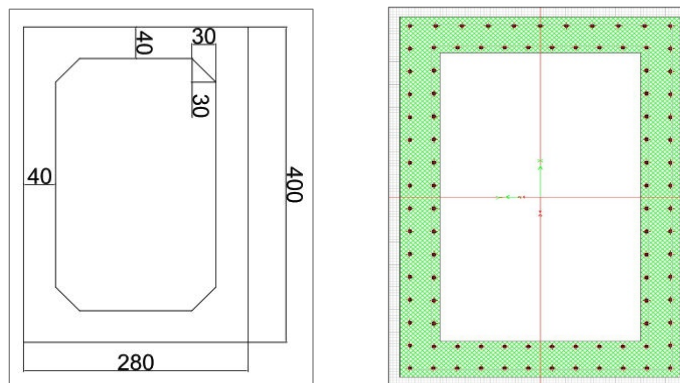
Dimensiones y distribución de refuerzo de las piernas de la pila del tramo de las dovelas de concreto.
